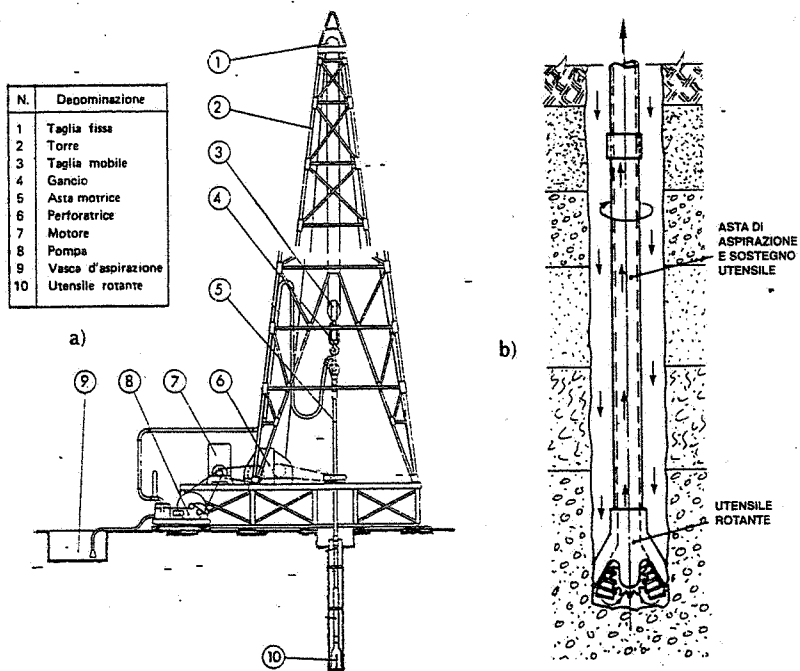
Modalità di perforazione con il sistema a rotazione e a circolazione inversa: a) schema dell'impianto; b) particolare della perforazione.
